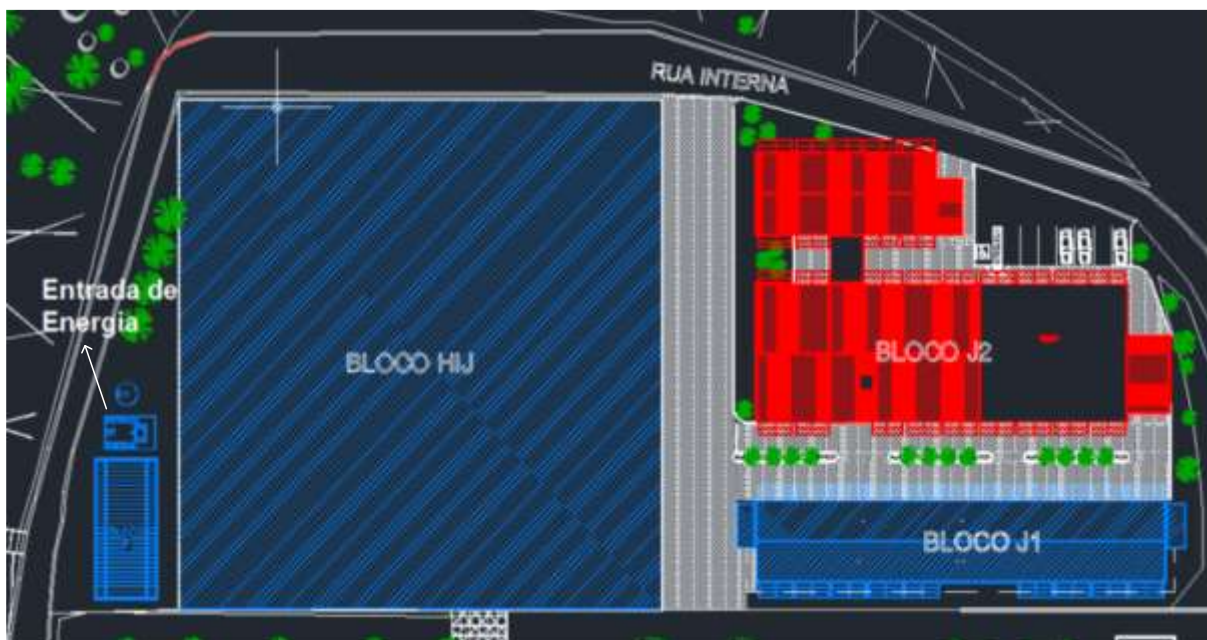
Planta Baixa UTFPR-PB, bloco HIJ e Entrada de Energia.
